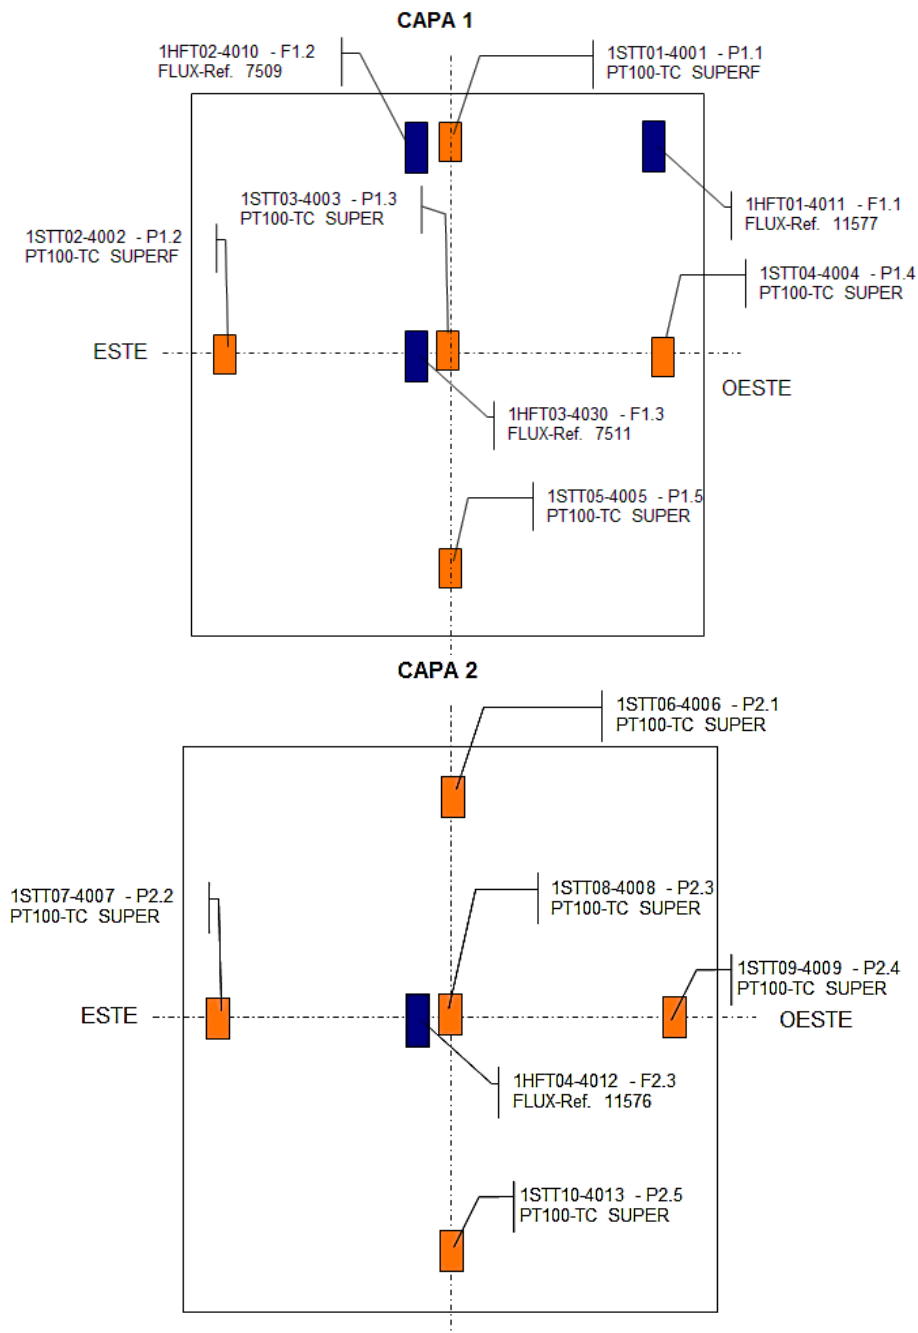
Disposición de las sondas en las capas de la muestra de muro base
